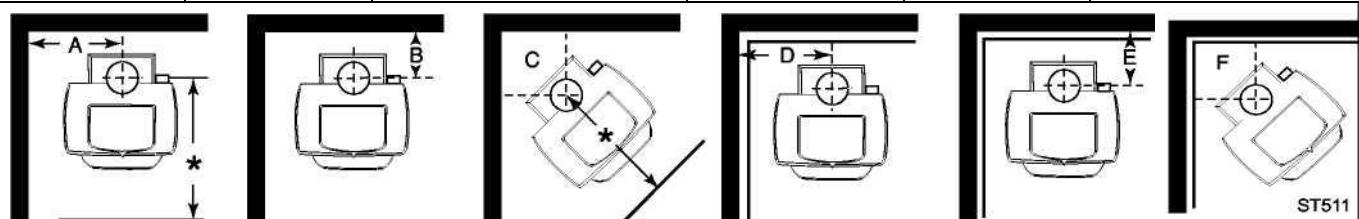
Угловая установка, вертикальный соединительный элемент дымохода, 2 тепловые изоляции. Сокращенное расстояние от боковой части. Изоляции стены ДОЛЖНЫ соединиться в углу.
